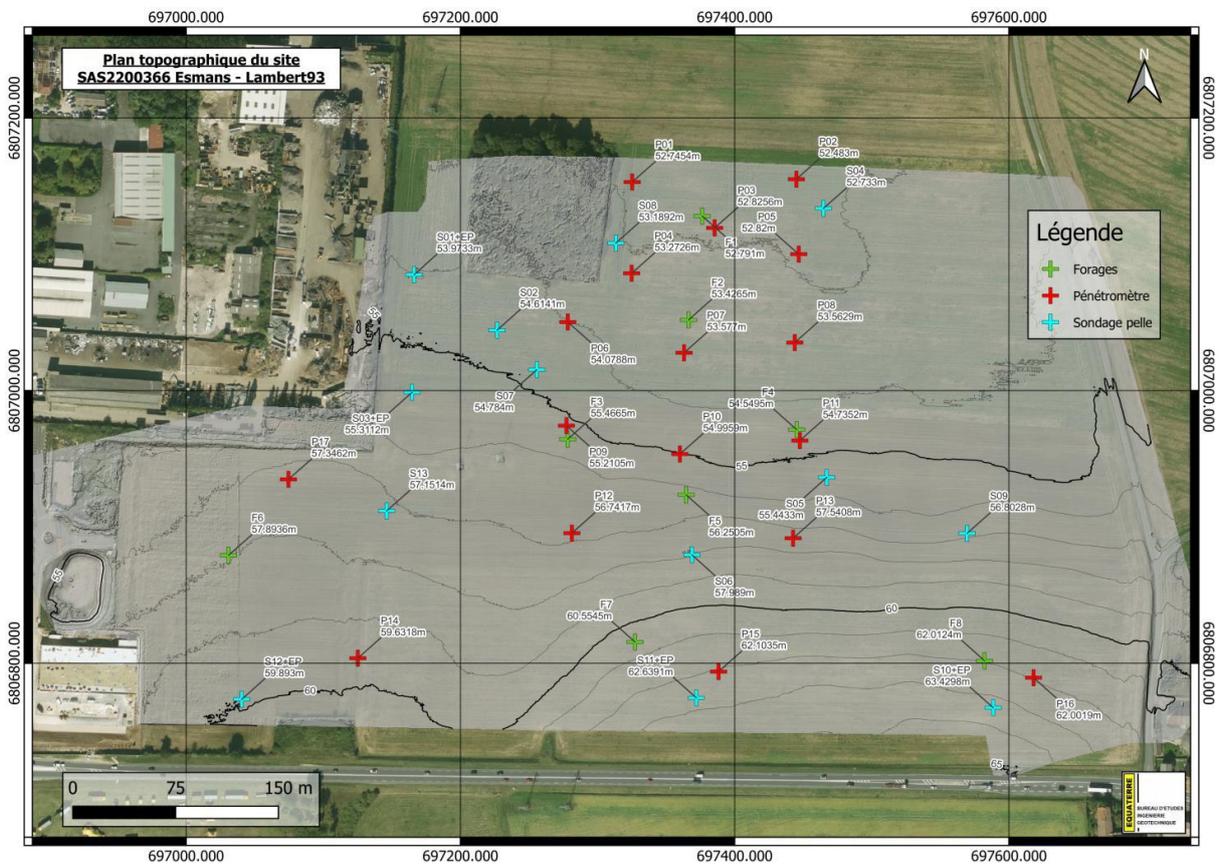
Plan topographique et d'implantation des sondages (source : EQUATERRE)
